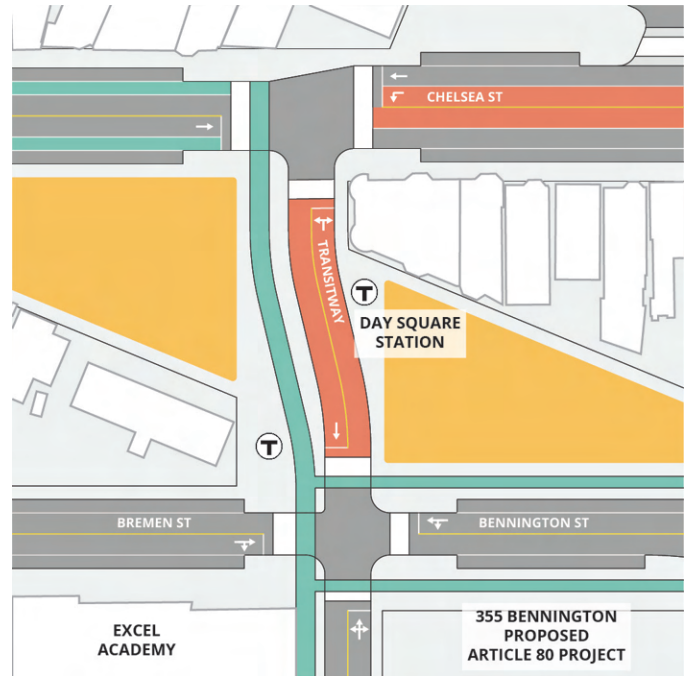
VÍA DE TRÁNSITO ENTRE BENNINGTON / BREMEN STREET Y CHELSEA STREET - CONDICIÓN PROPUESTA
